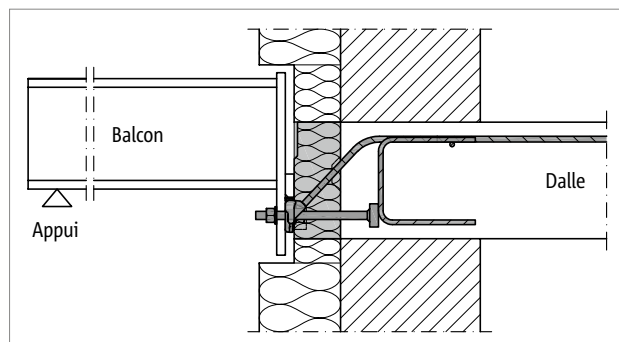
Schöck Isokorb® T type SQ : passage sans obstacle grâce au décalage en hauteur
